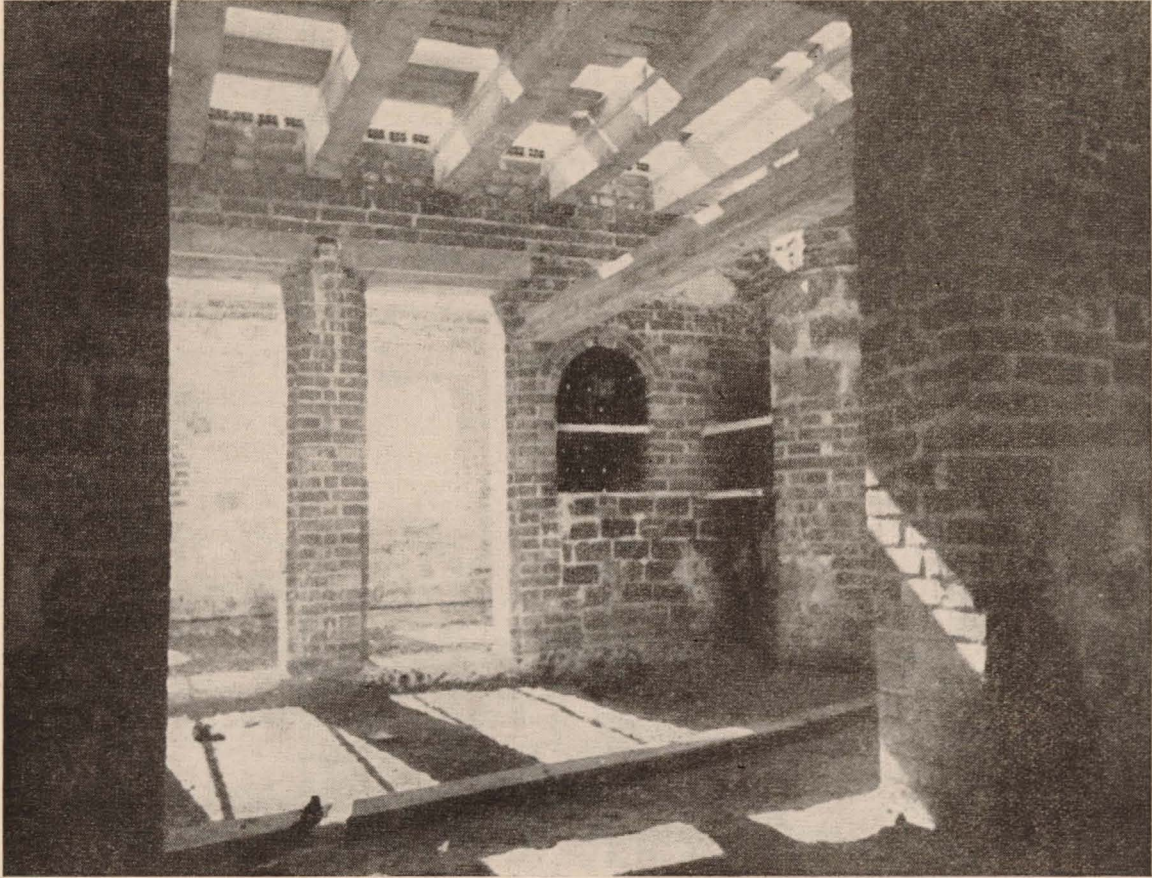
Viguetas de hormigón armado con piquetes de alambrada, empleados en Brunete.
